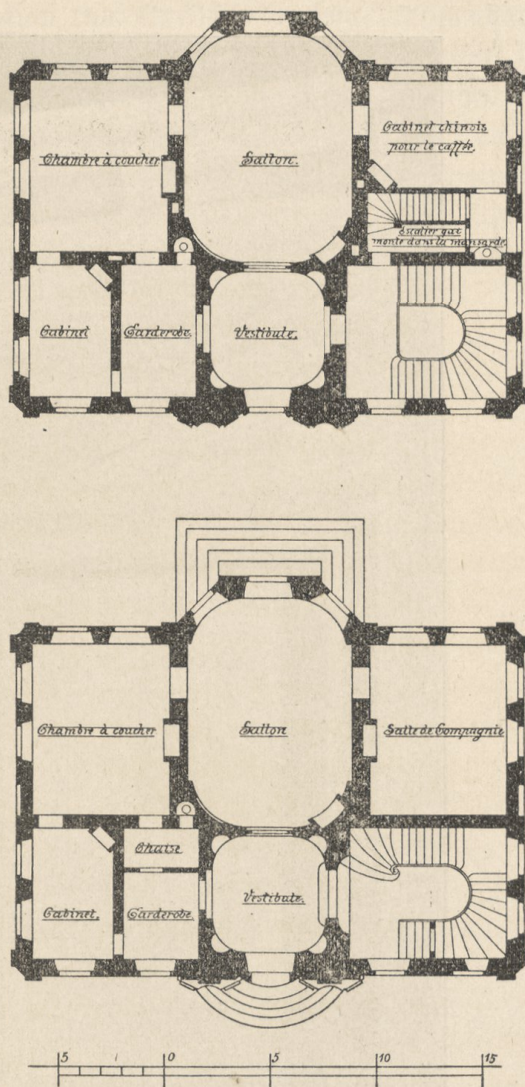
Falkenlust, Grundriss (nach Cuvilliés' Stichwerk, Gesamt-Ausgabe. 1770).
